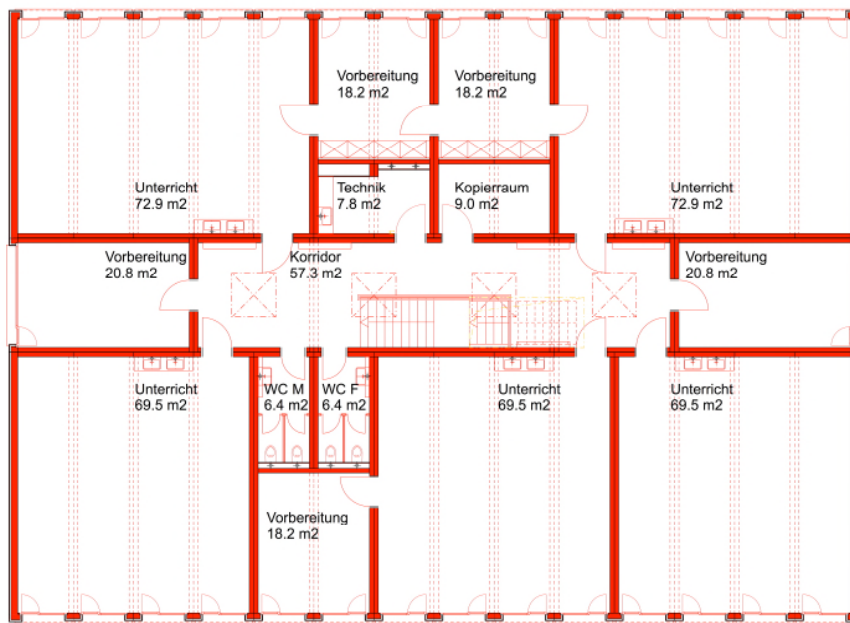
Grundriss 2. Obergeschoss (Aufstockung)
